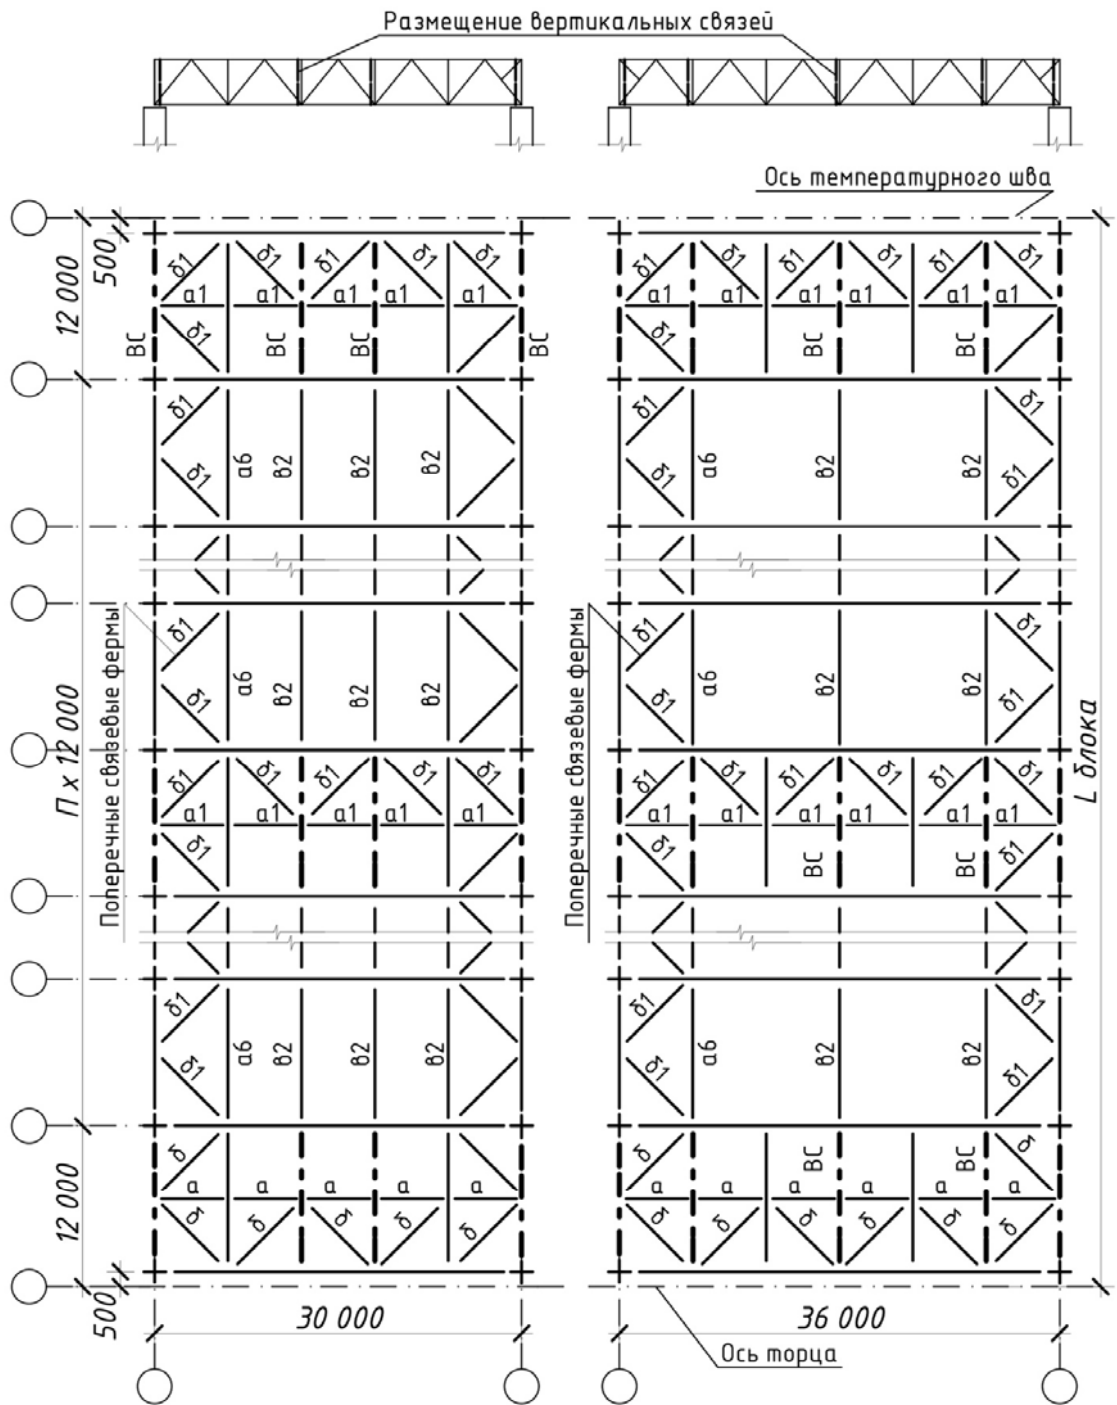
Схемы расположения связей I-го типа по нижним поясам стропильных ферм, шаг ферм 12 м, пролет 30 - 36 м.
